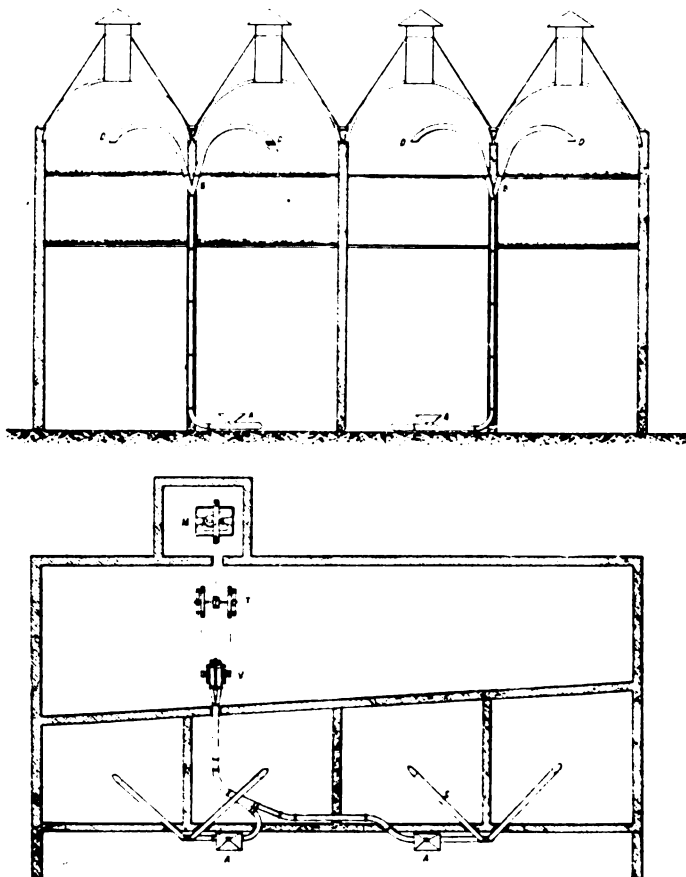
et 4. — Coupe et plan d'une installation d'élévateur transporteur soufflant, dans une brasserie.
